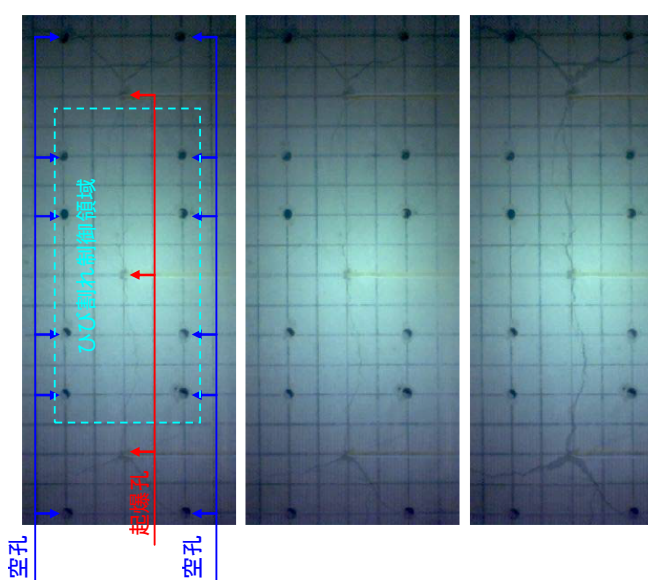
ハイスピードカメラによるひび割れの発生・成長
